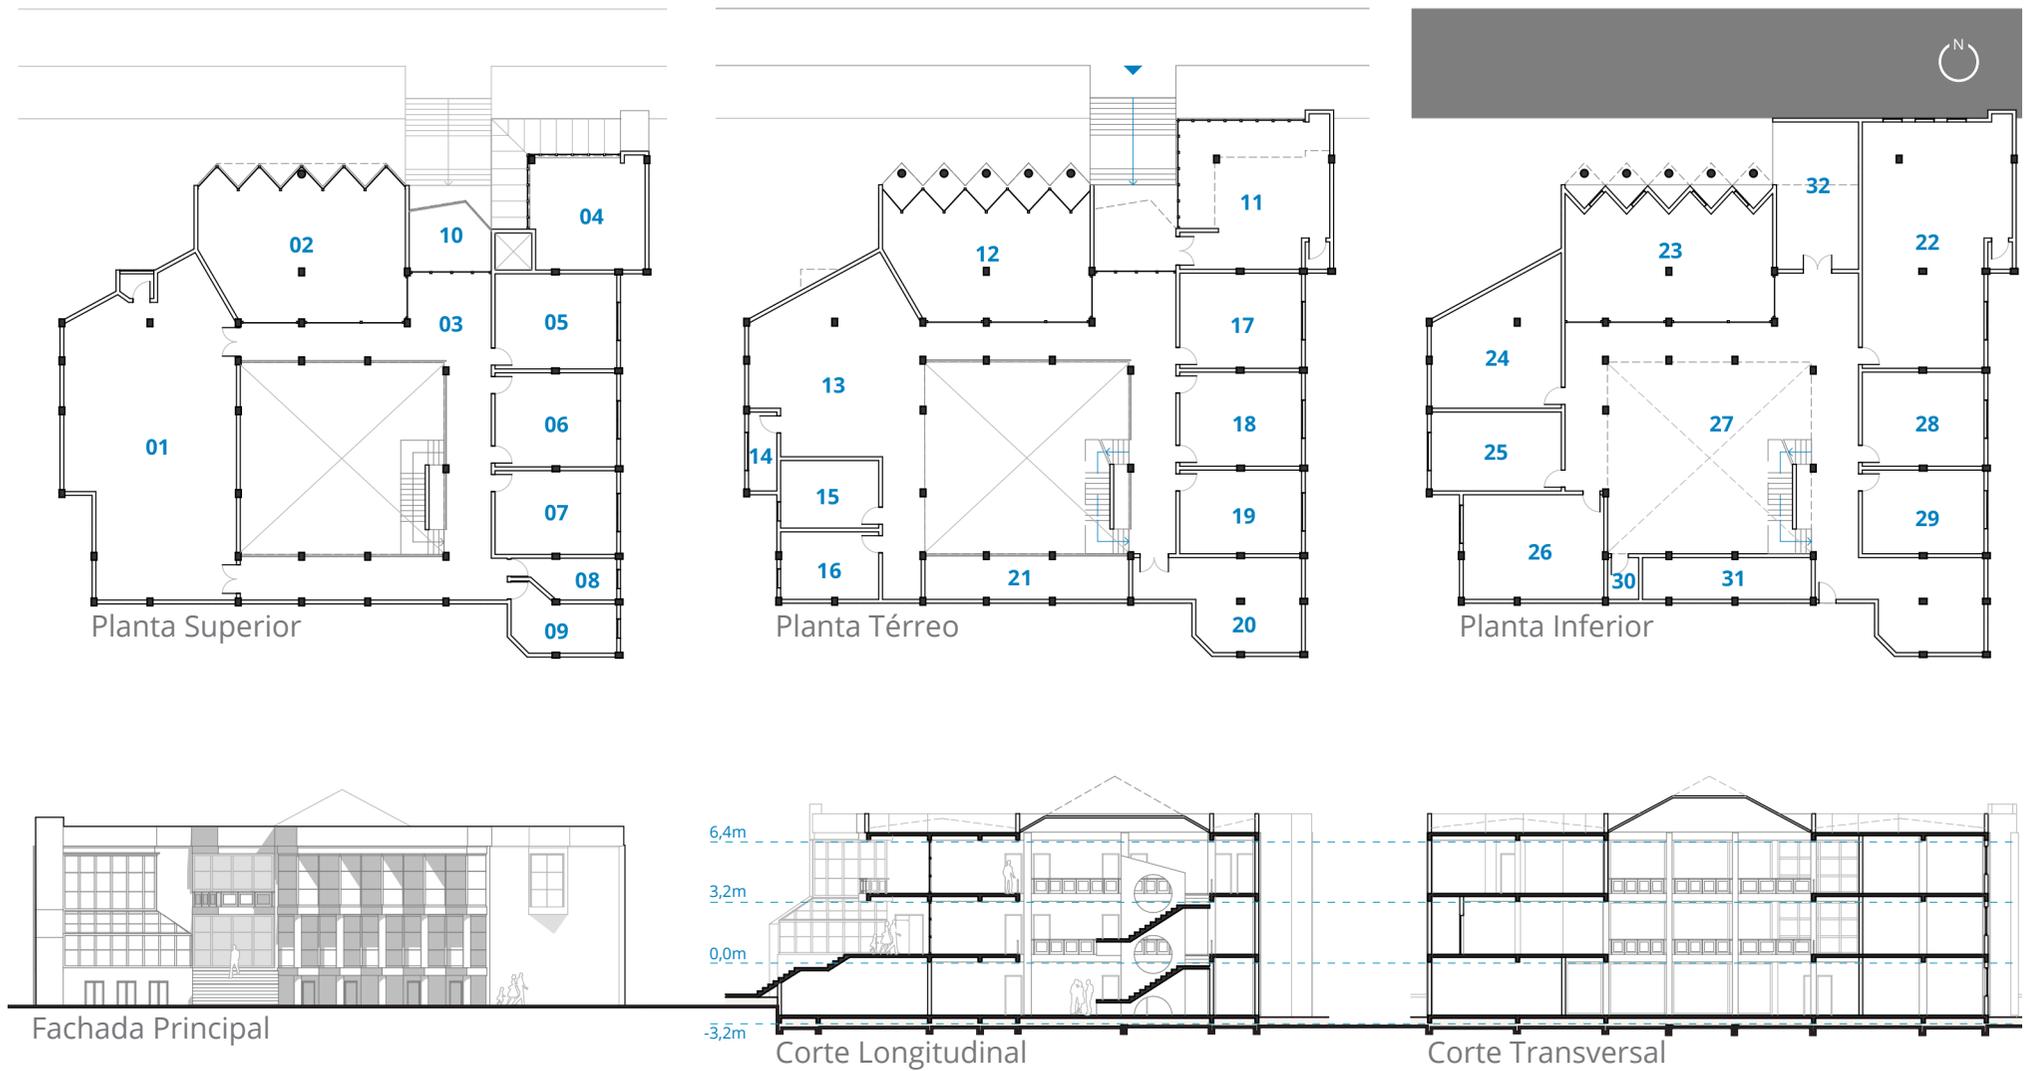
Plantas, cortes e fachada principal da Casa de Cultura.
